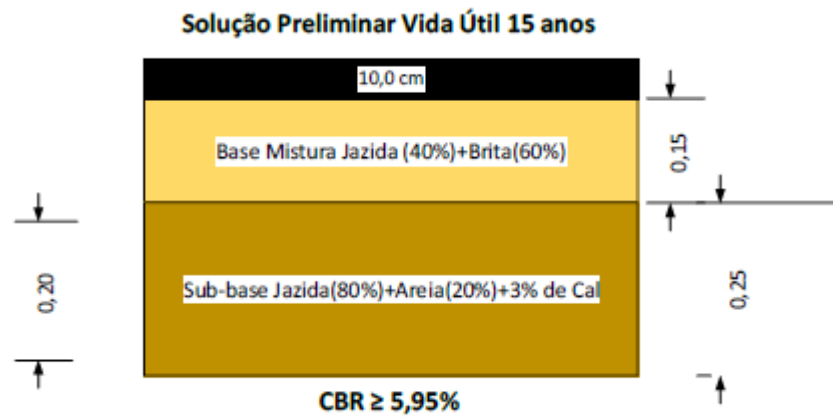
Seção Típica Pavimento Vida Útil 15 anos
